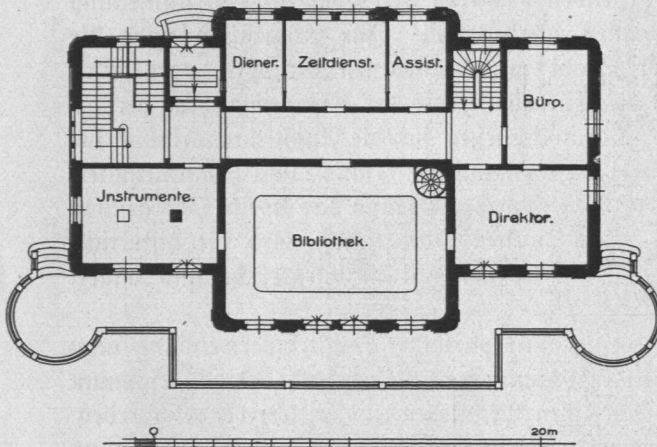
Sternwarte, Hauptdienstgebäude, Erdgeschoss, Grundriß.
